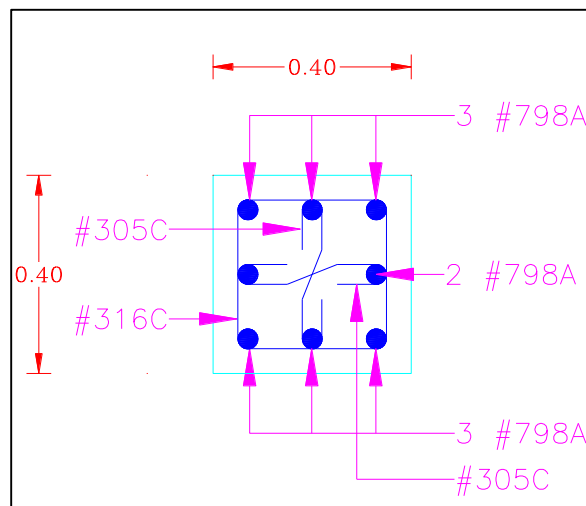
Detalle de refuerzo columnas 40 x 40 (cm) unidad sanitaria.
